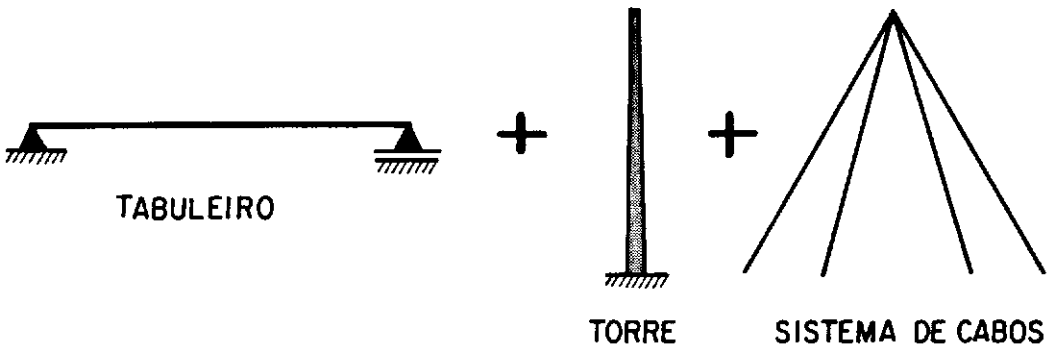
PONTE ESTAIADA E COMPONENTES ESTRUTURAIS.
